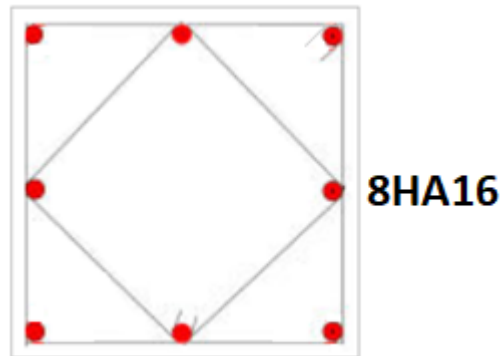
Schéma de ferrailage des poteaux de section 40 X 40 cm
